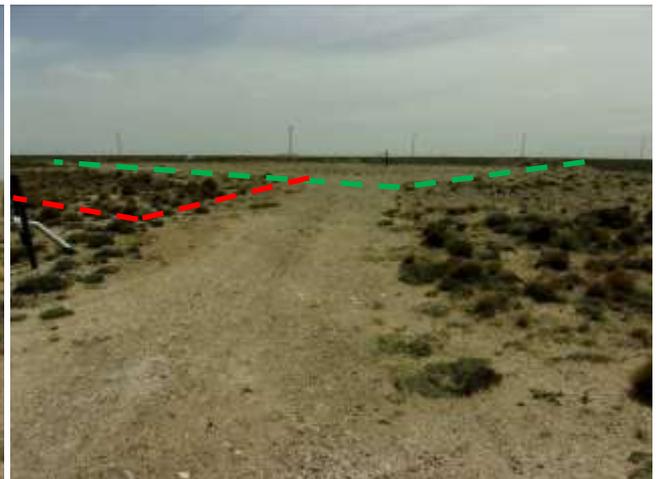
Vértice NO de la locación existente (Verde) Vértice NO de locación propuesta (Rojo). Foto en dirección E.
